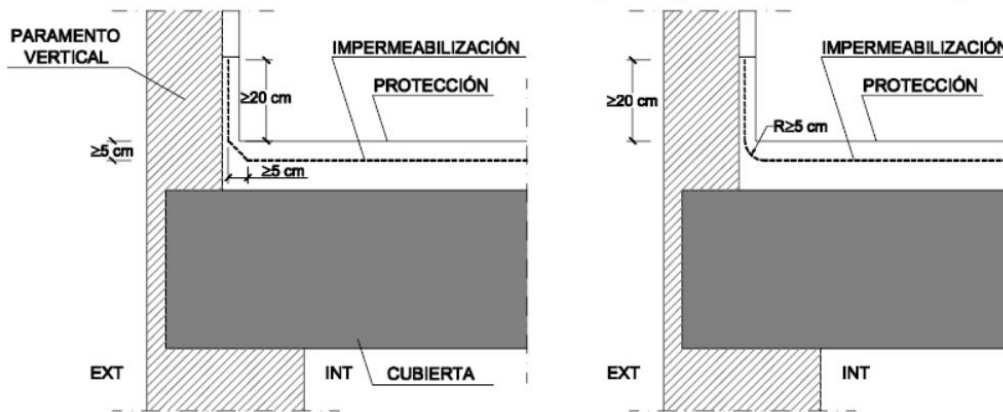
Encuentro de la cubierta con un paramento vertical
